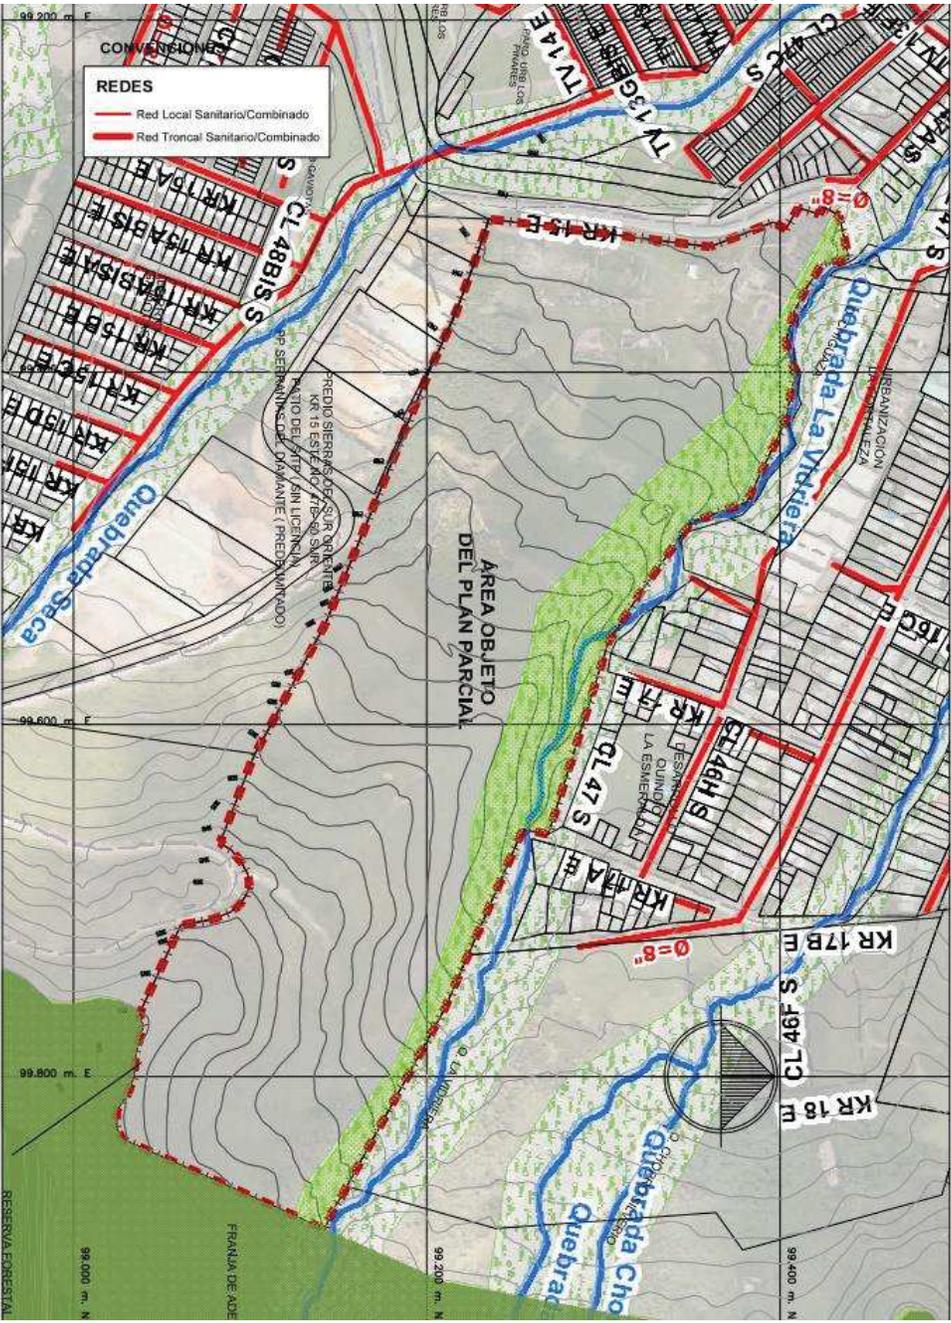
Estructura de servicios públicos - Redes de Alcantarillado Sanitario
